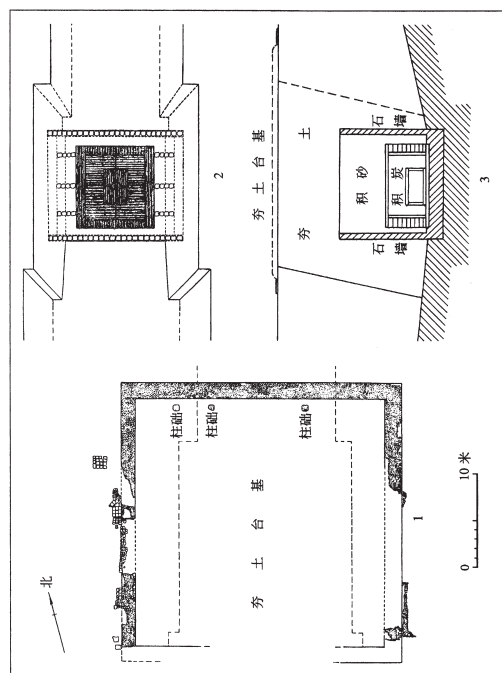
河南省辉县固圉村 M2 平·断面图 (1/800)
